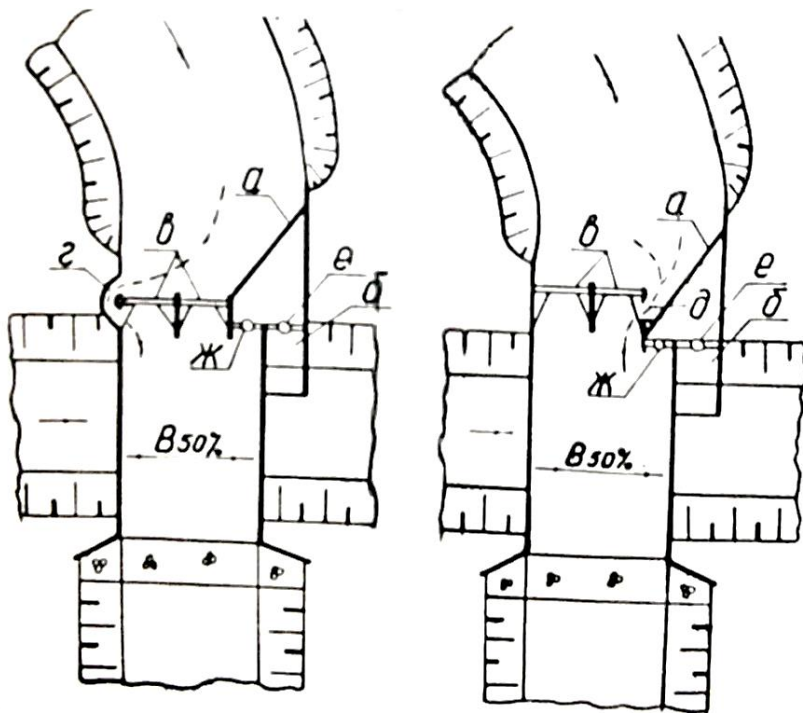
Улучшенные схемы водопроводяще-водозаборных сооружений для неселеопасных участков рек: а – струенаправляющая стенка (она же водоприемный водослив); б – подпитывающая камера; в – речные затворы; г, д – промывные отверстия; е – затвор подпитывающего пролета; ж – затвор сбросного пролета; з – водоприемная камера.
